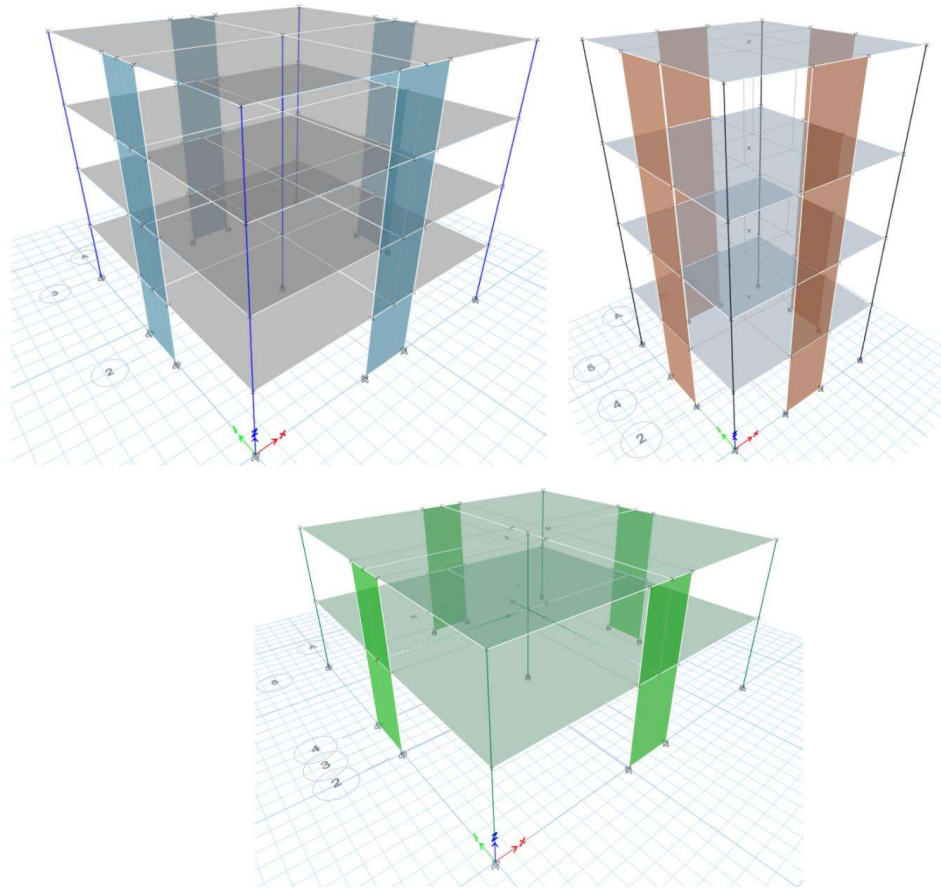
Vista 3D de los tres modelos estructurales, ETABS
